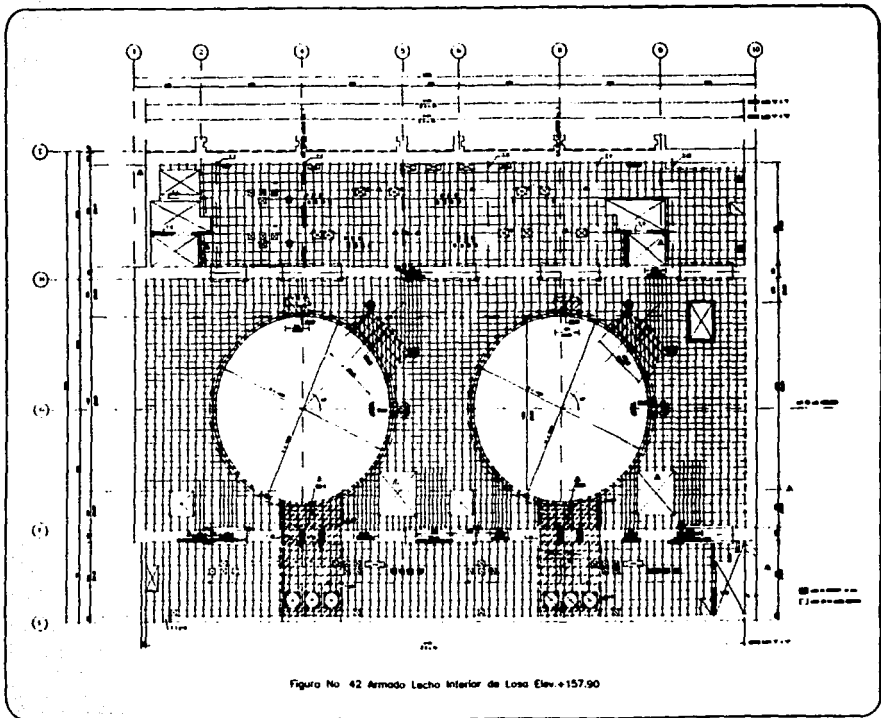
Armado Lacho Interior de Lona Elev. +157.90
